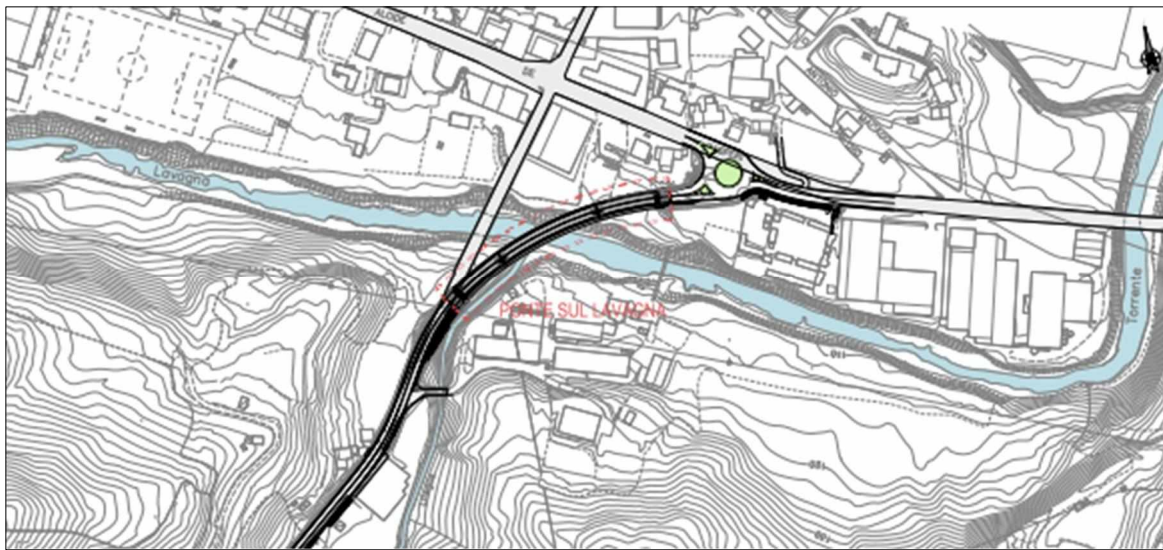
Dettaglio planimetrico in località Ferrada di Moconesi
